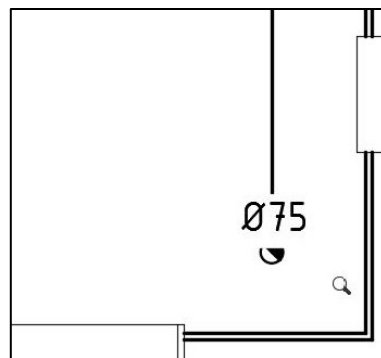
Bajante pluviales. 2016. Plano PByE.
